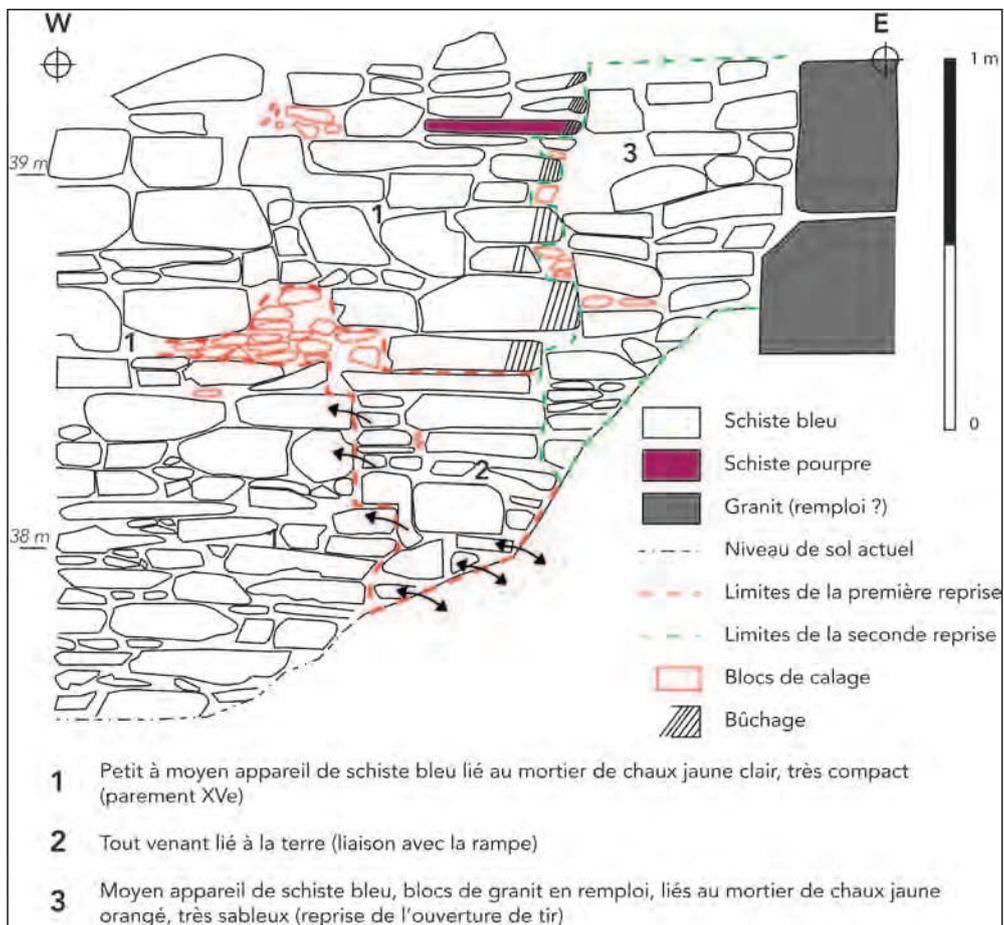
Relevé pierre à pierre d'une partie du panneau gauche de la première poterne
